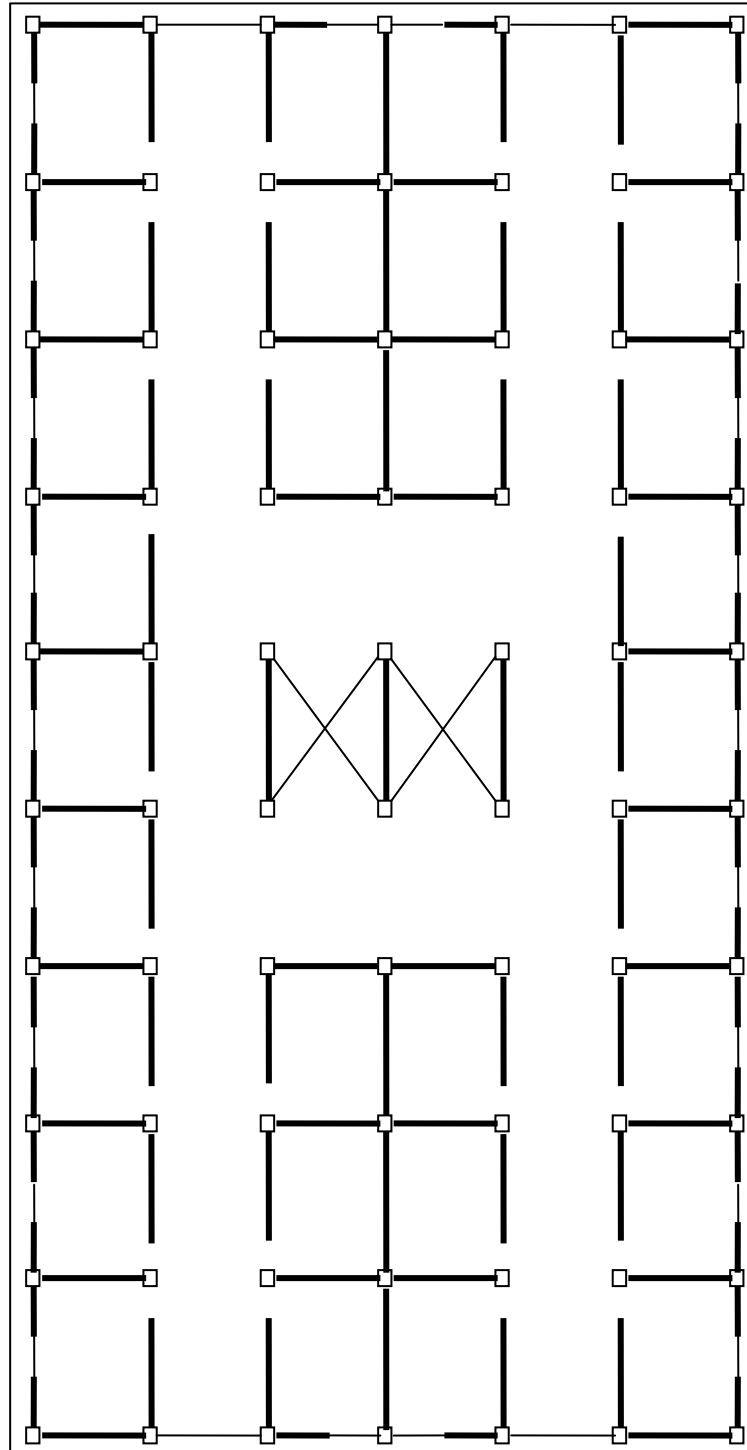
Planta arquitectónica del edificio de 21 niveles.
